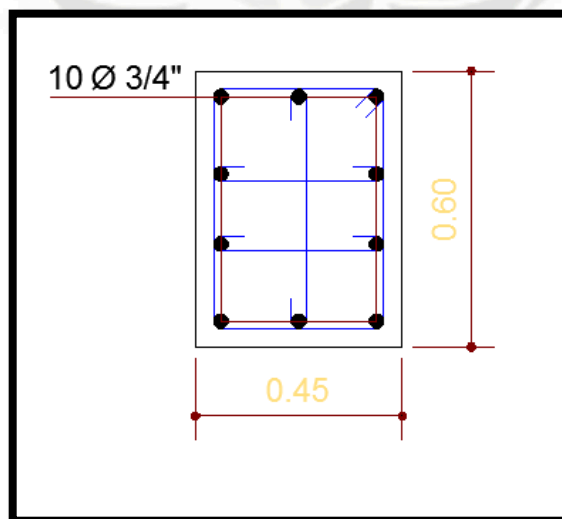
DISTRIBUCIÓN DE ACERO DE LA COLUMNA C-1
